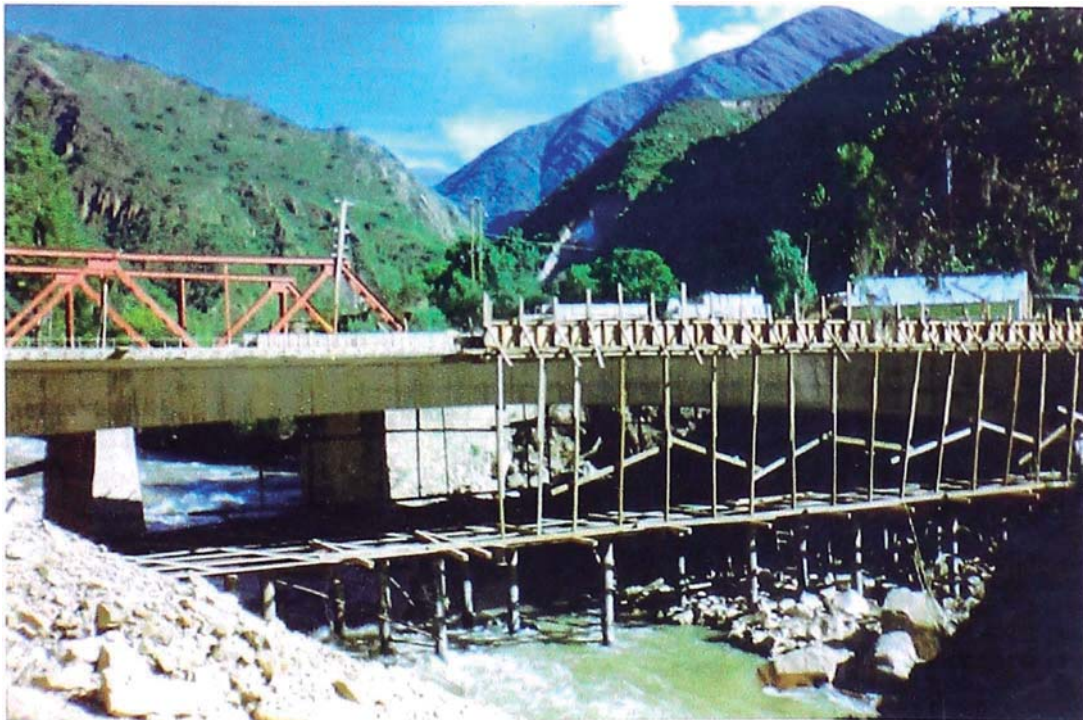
Se aprecia el encofrado de las veredas, algunos pilotes han sido arrancados de su posición por el río.
